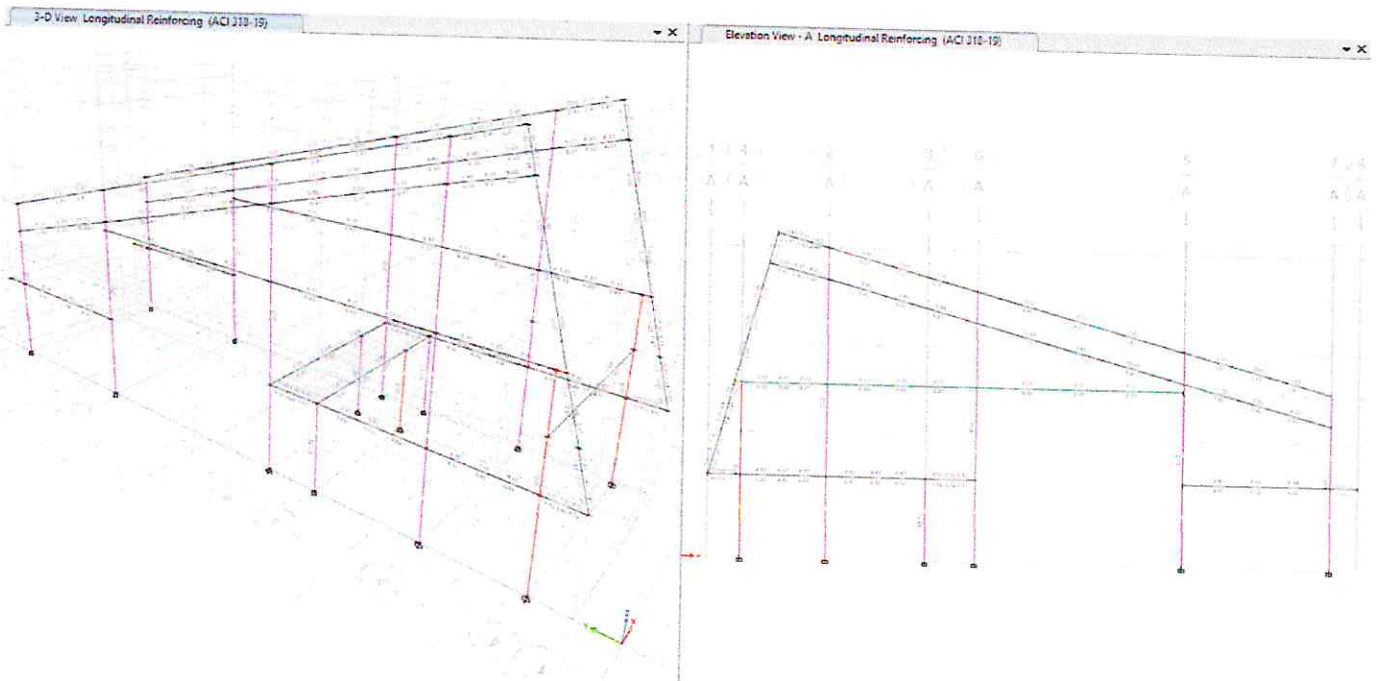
Acero de refuerzo longitudinal por flexión en vigas – Bloque C
